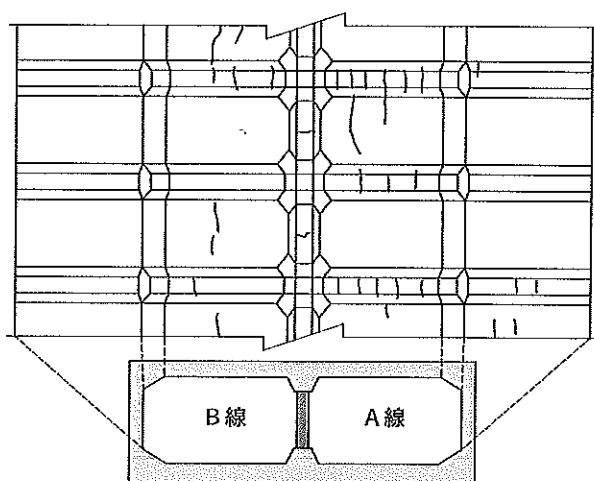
構造ひび割れ展開図(0.3mm以上)²⁾
